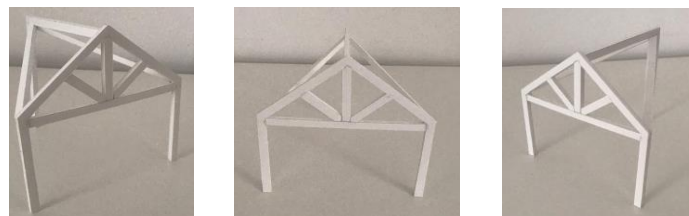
Maqueta 1 em k-line, escala: 1/25
